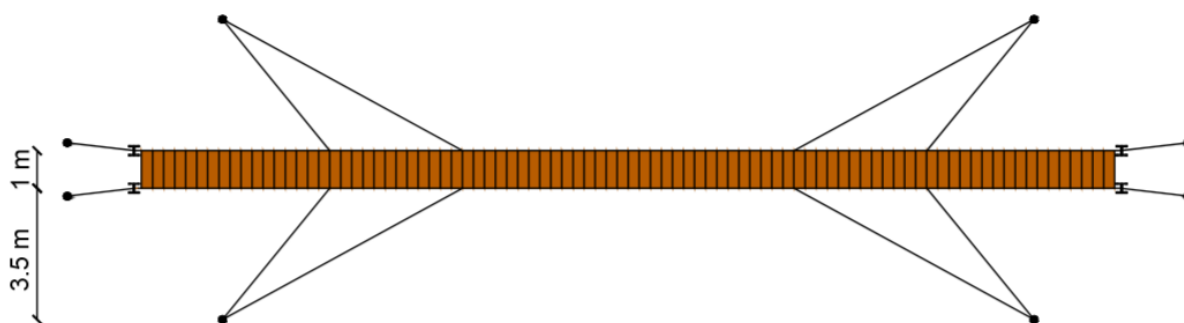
Dimensões da ponte em estudo em Planta.
